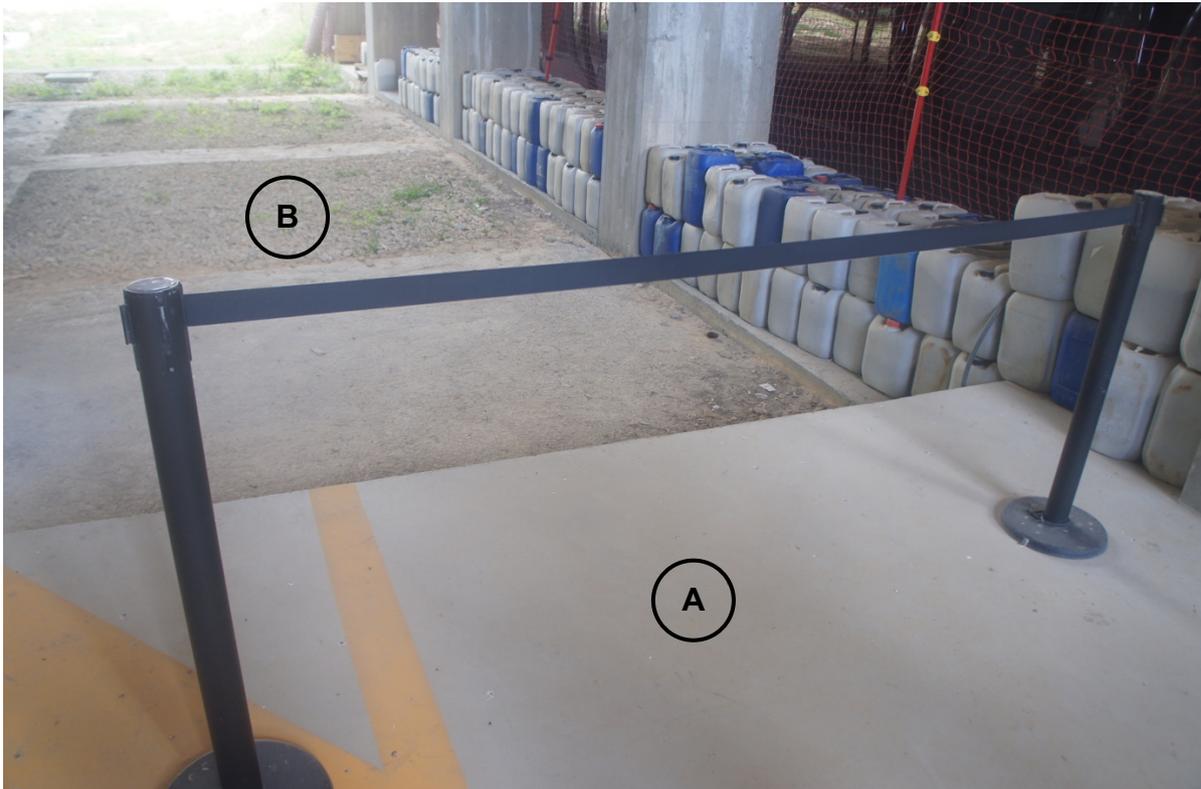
Paletti con nastro estraibile per l'interdizione all'accesso della zona B
